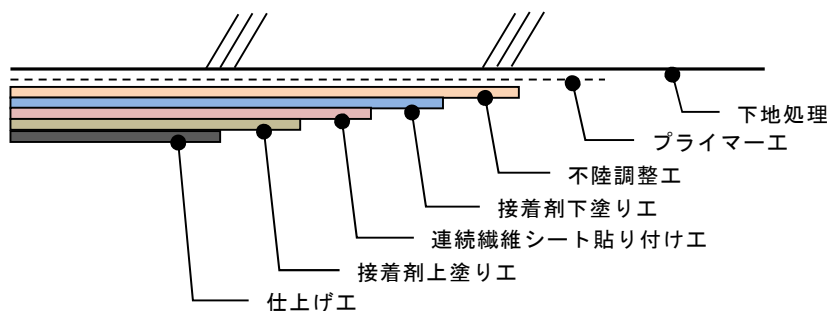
連続繊維シート巻立て工法の施工断面例
